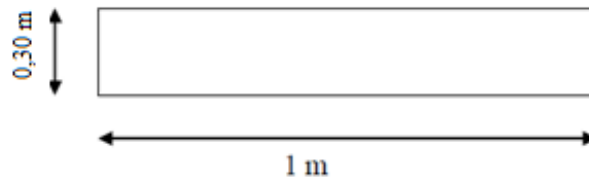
Section du calcul du ferrailage pour mur de soutènement
